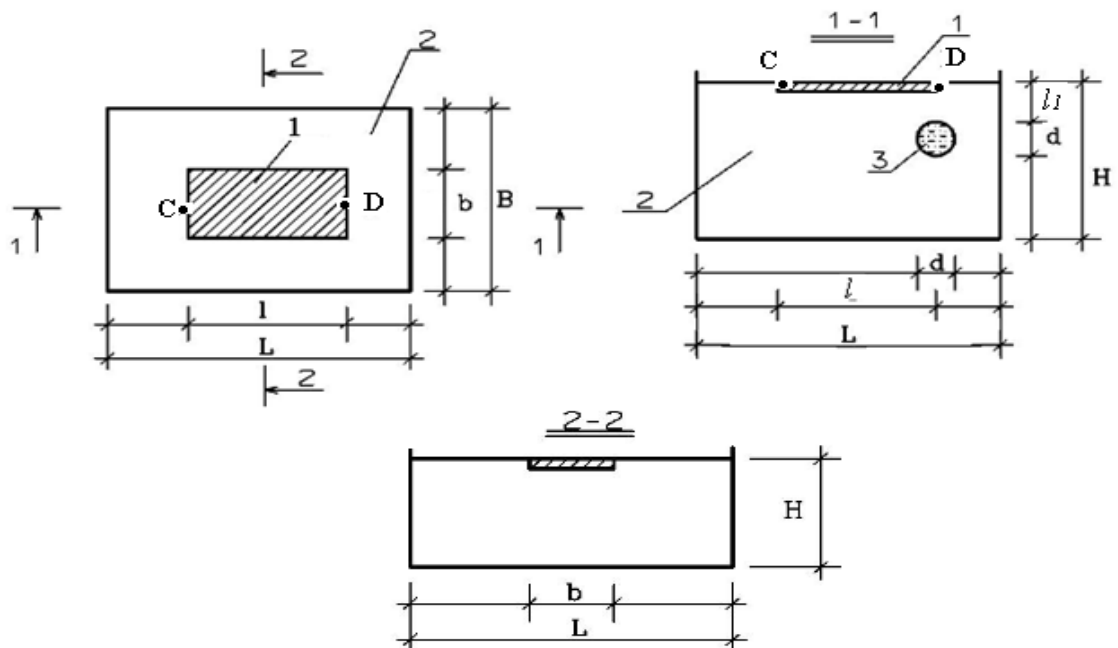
Схема системи «ґрунтовий лоток – основа – фундамент». Примітка: на цій схемі немає розмірів надфундаментної будови
